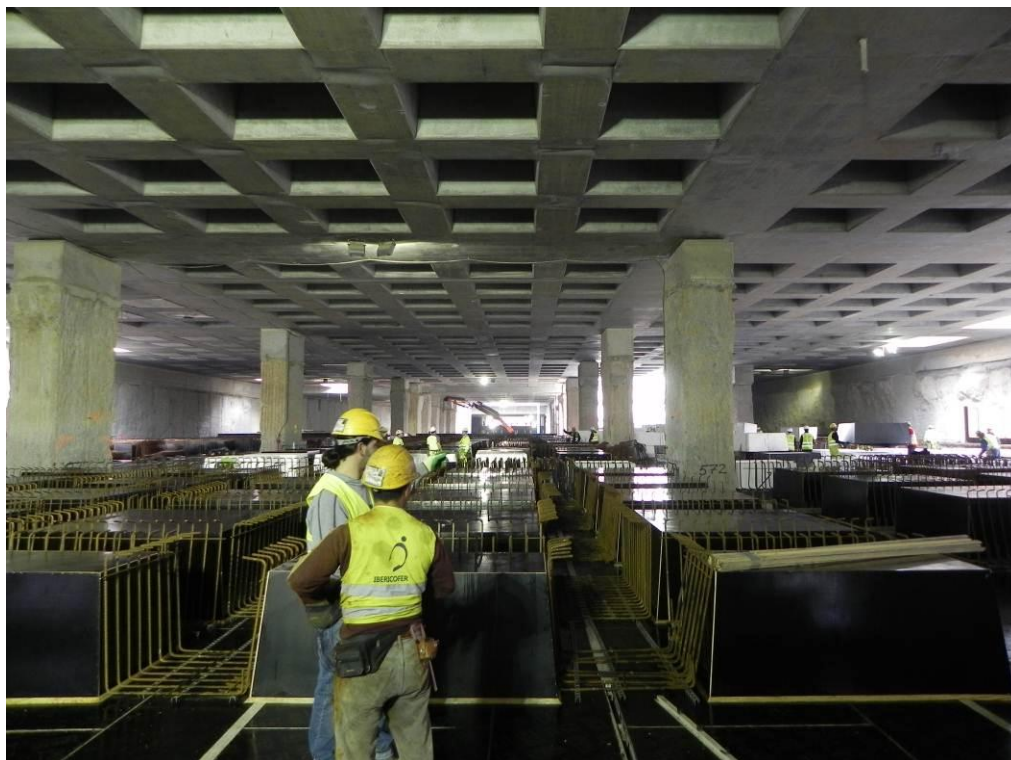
Vista del telescopio sur de la estación en la fase en la que se está ferrallando la contrabóveda.
